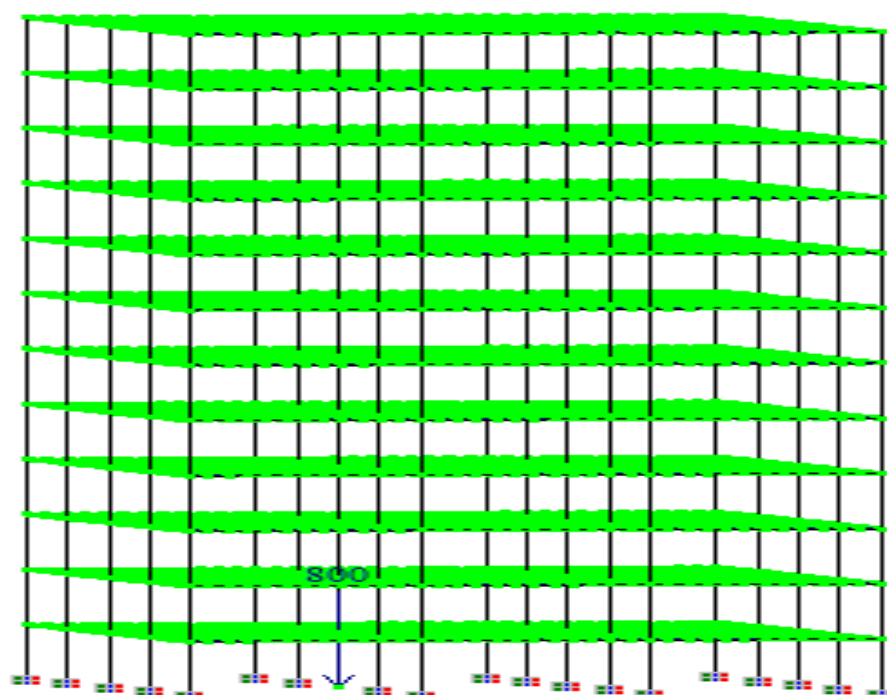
Schéma illustratif du modèle d'étude du bâtiment avec planchers en hourdis à 12 niveaux avec un chargement vertical sur le poteau de rive
